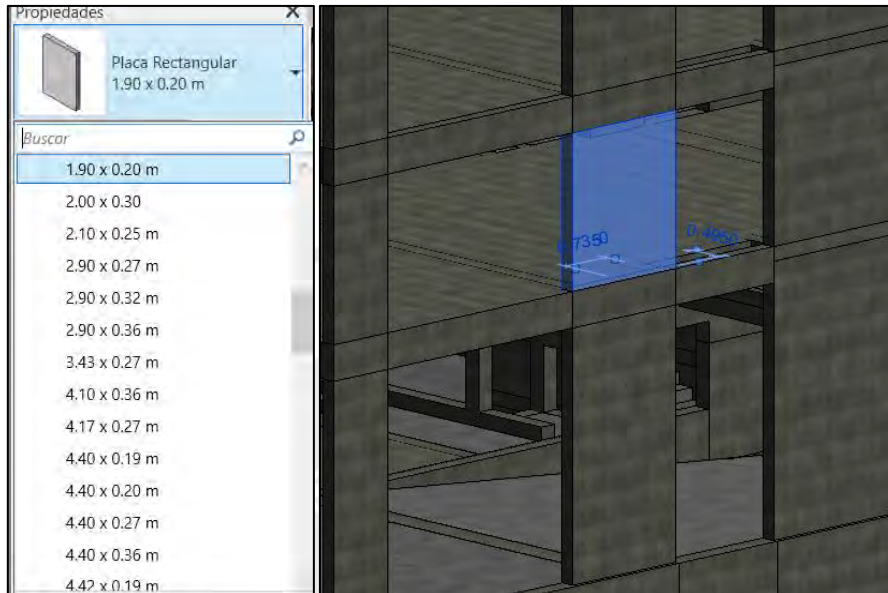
Familia y tipos para las placas en el modelado 3D
